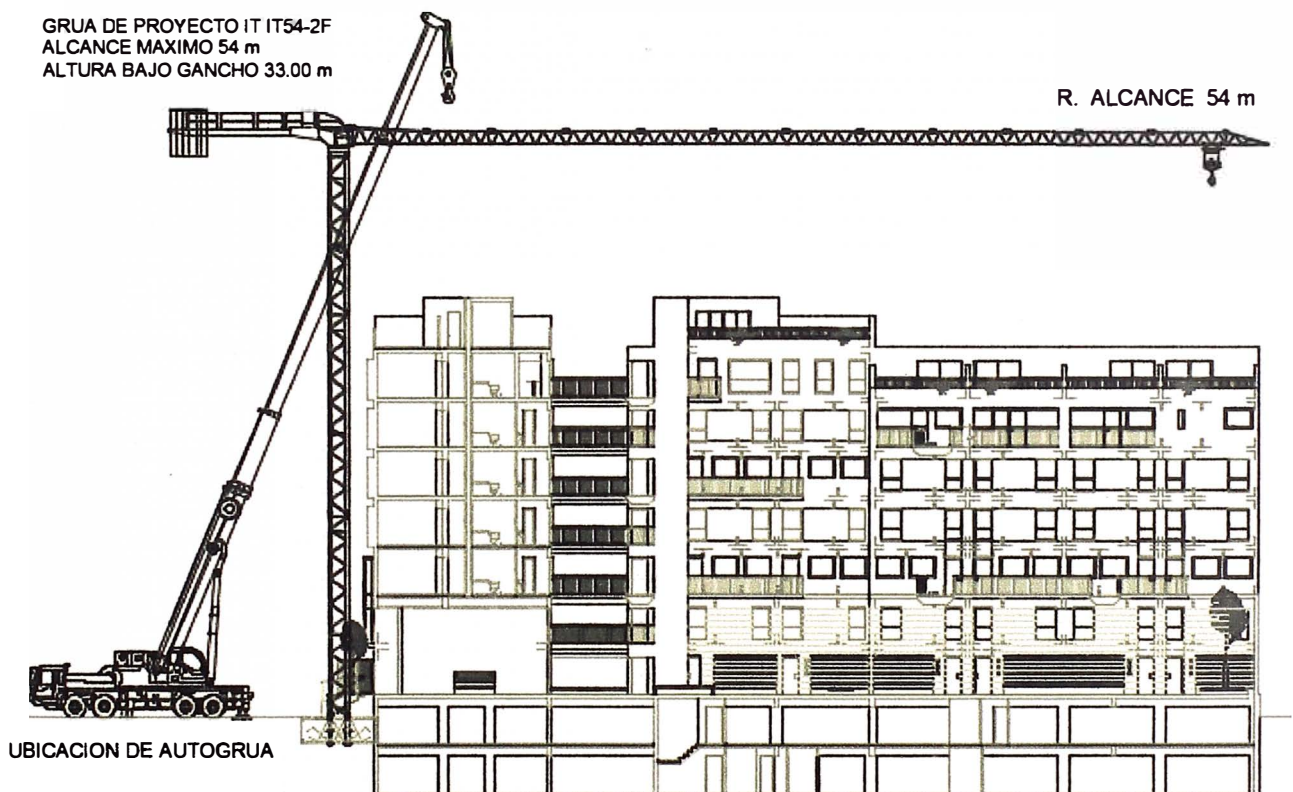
Características Instalación de Grúa Torre en obra estudiada.
